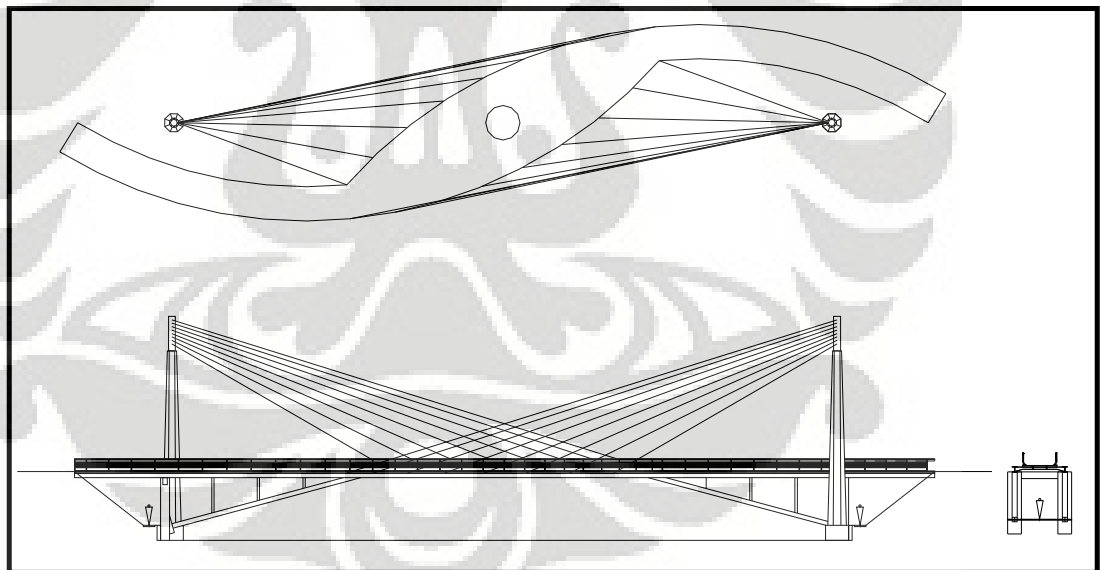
Detail Struktur Gelegar Jembatan Pejalan Kaki
